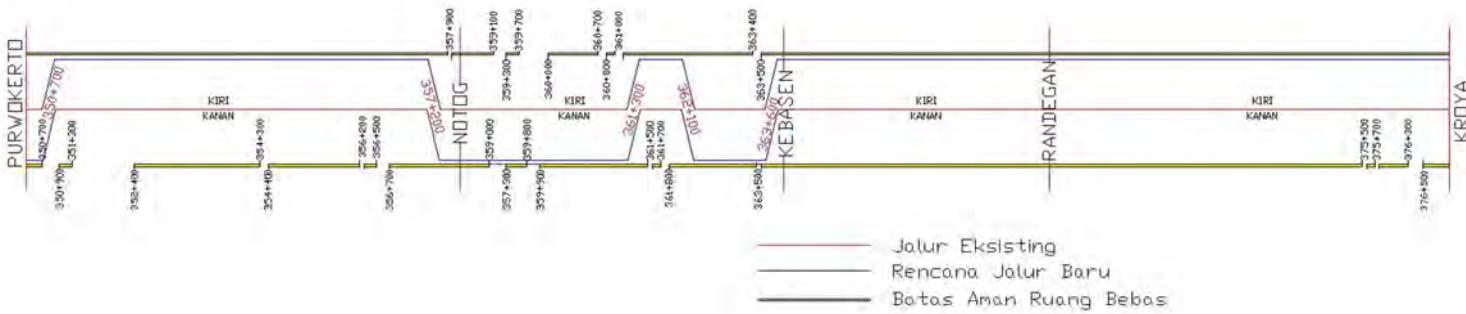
2 Track Layout Ruang Bebas dan Ruang Bangun
